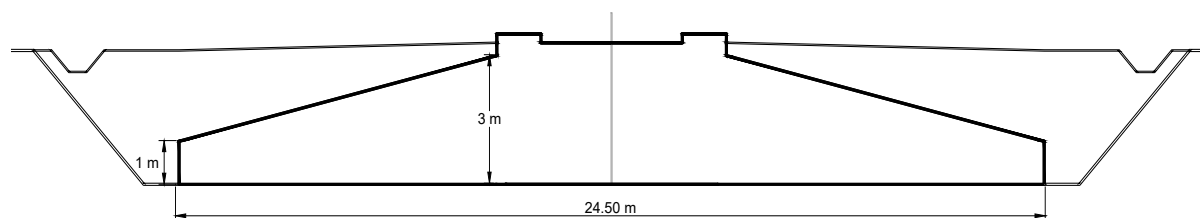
Tipico sezione fondazione Aerogeneratore
